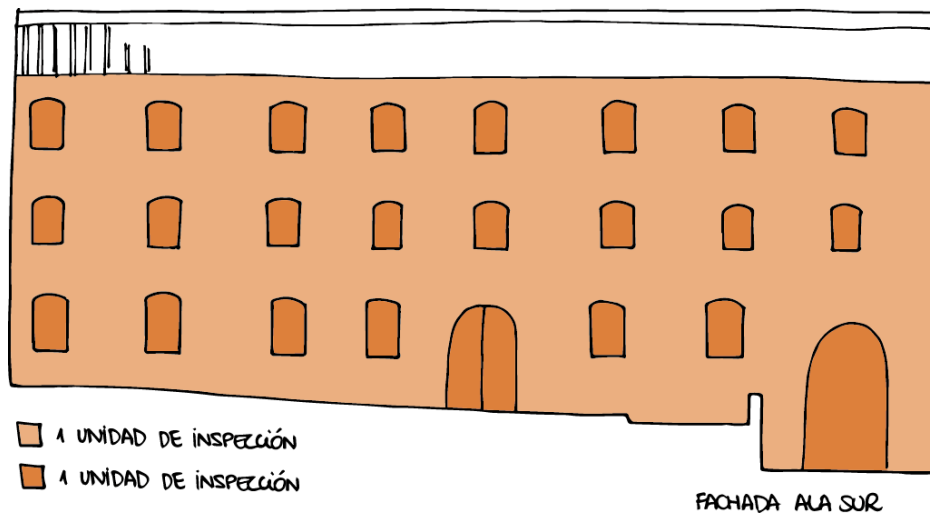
Ámbito de actuación y unidad de inspección de la fachada y la carpintería exterior.
